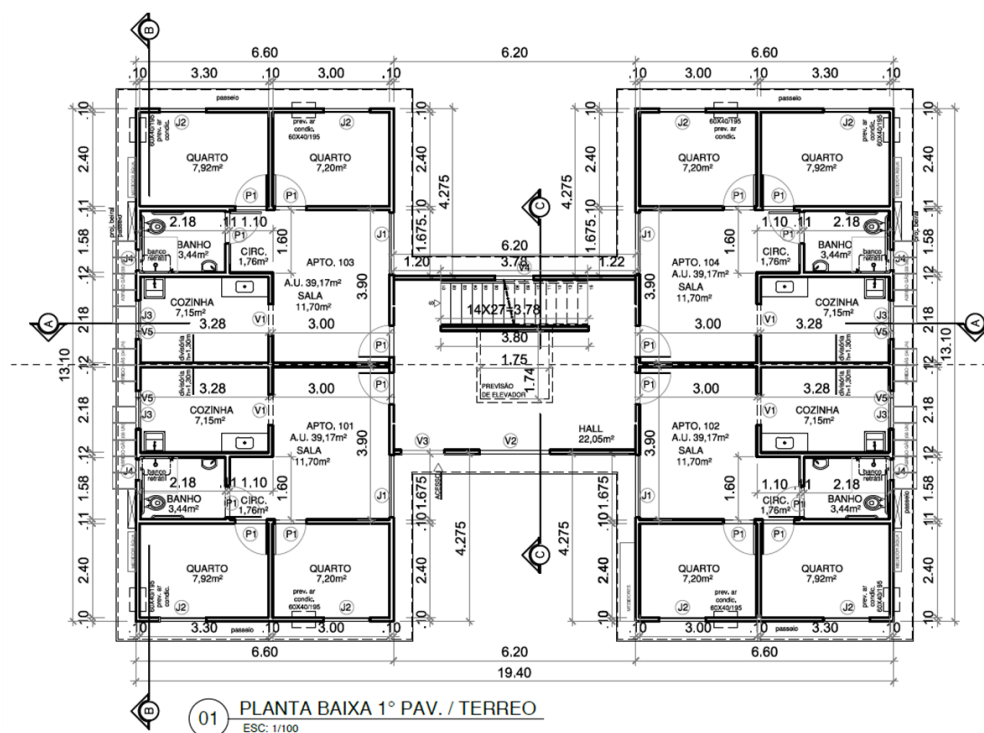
Planta baixa. Fonte: GUILLÉN, 2013.
